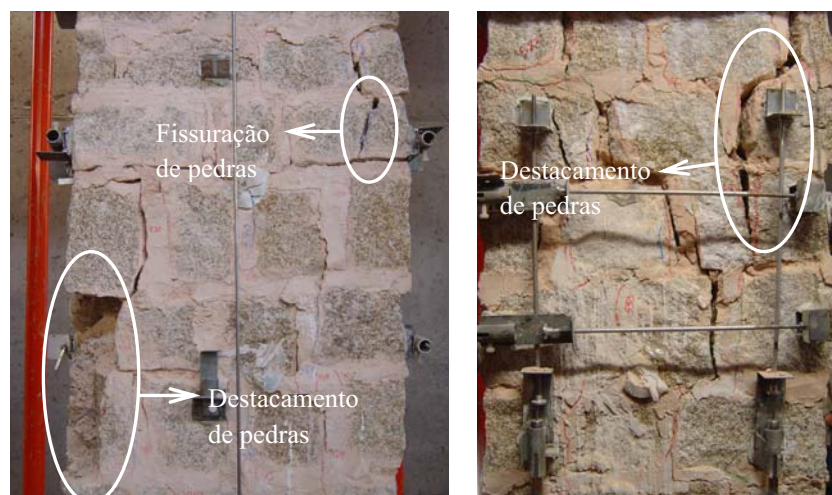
Mecanismos de colapso localizados das paredes reforçadas com pregagens transversais: fissuração e destacamento de pedras do pano externo.
